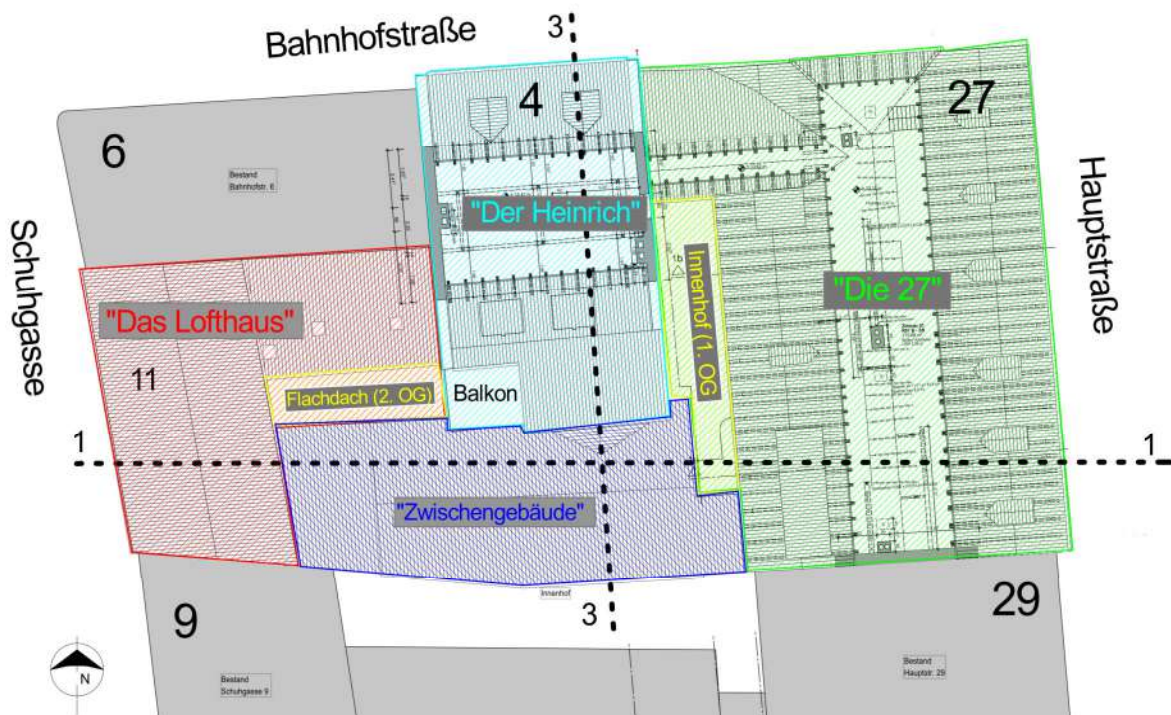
Grundriss Spitzboden vom Bestand (U2.14, ergänzt)
